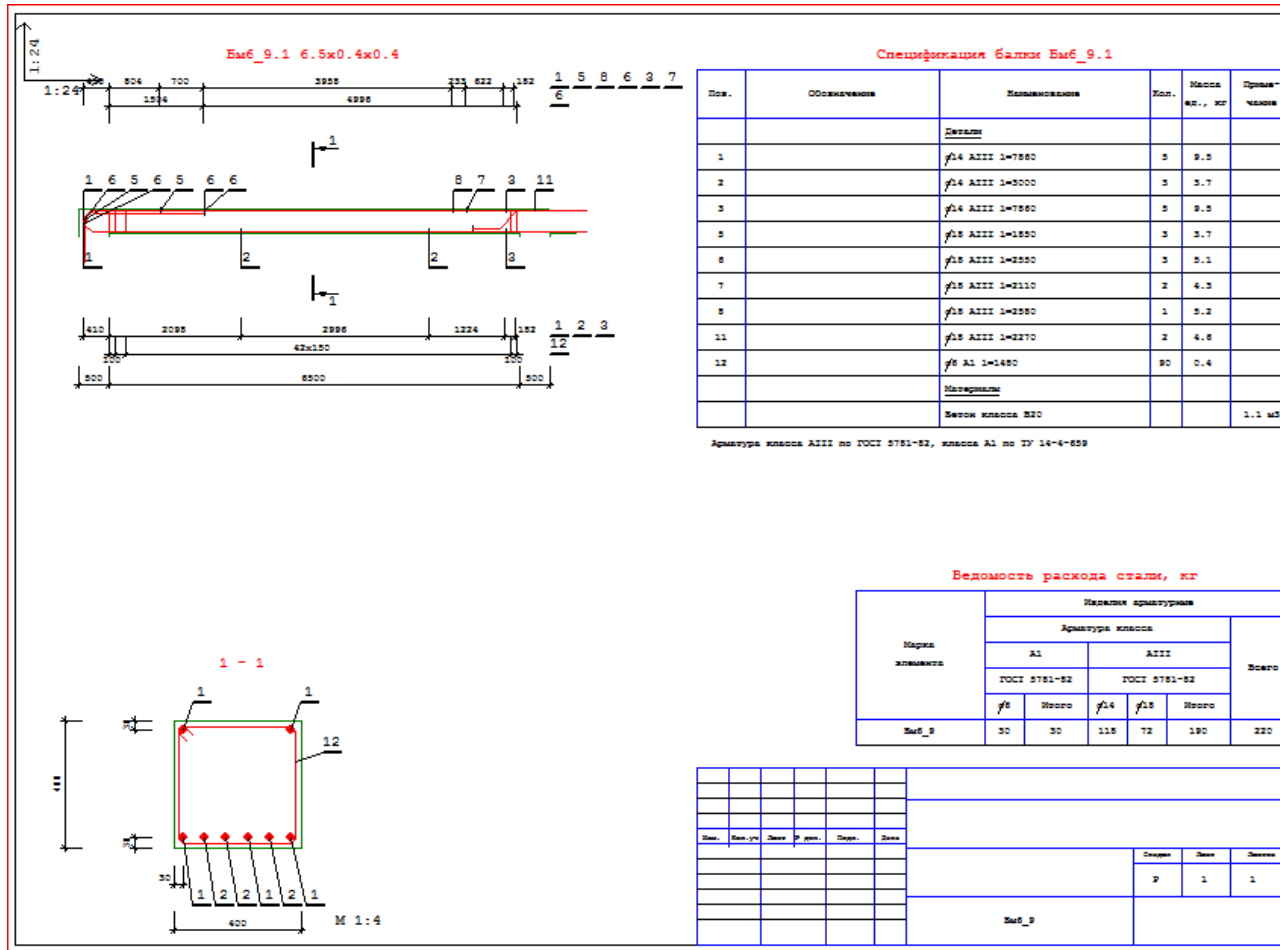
Вариант балково-плитного перекрытия. Балка Бб-9. Креслення робочого проекту
